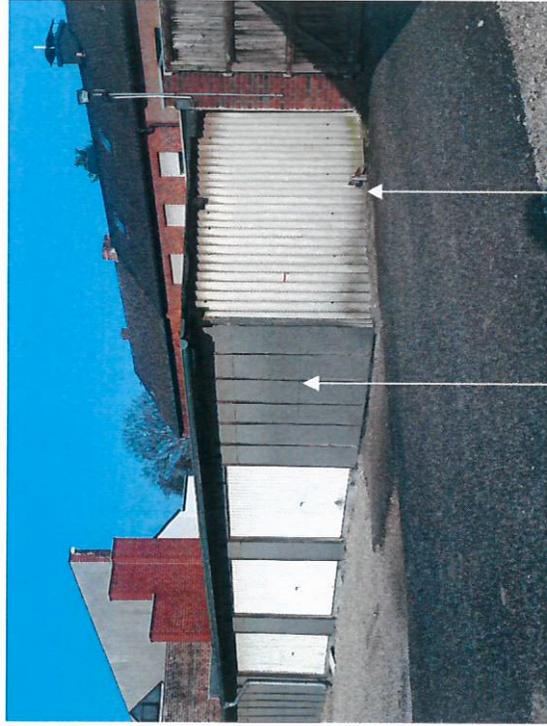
Garagen mit Dachpappe und Wellasbestzement
